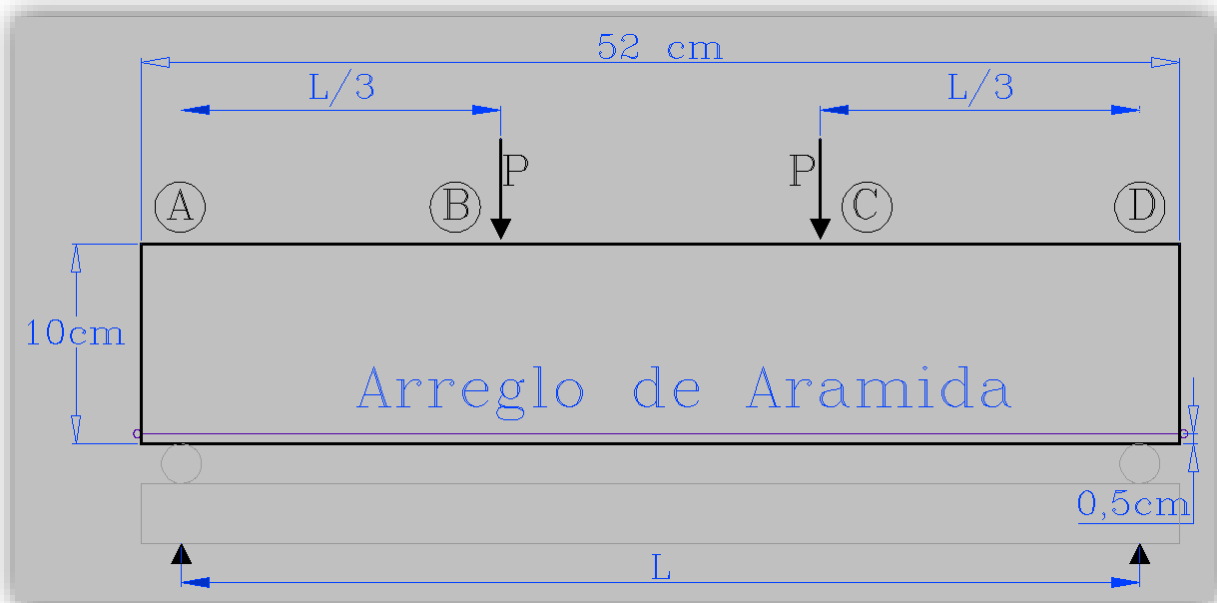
Configuración longitudinal de las vigas reforzadas con fibras de Aramida
